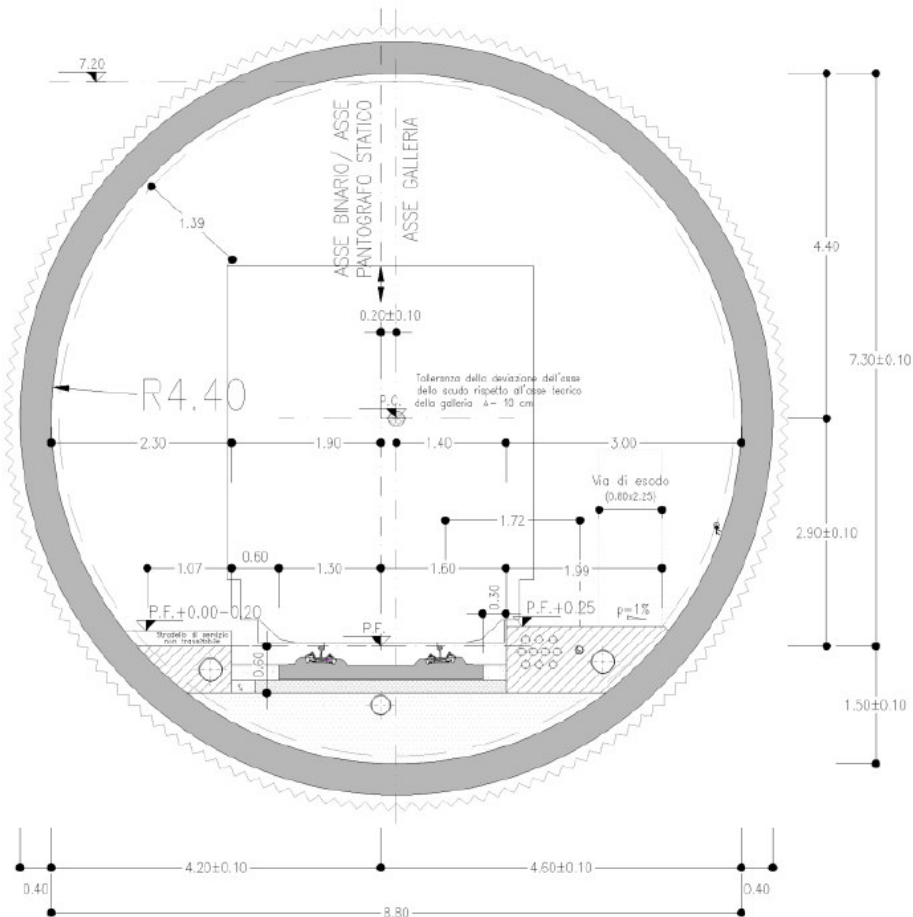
Sezioni di intradosso scavo meccanizzato singolo binario con armamento su piastra (Rif.[7.])
